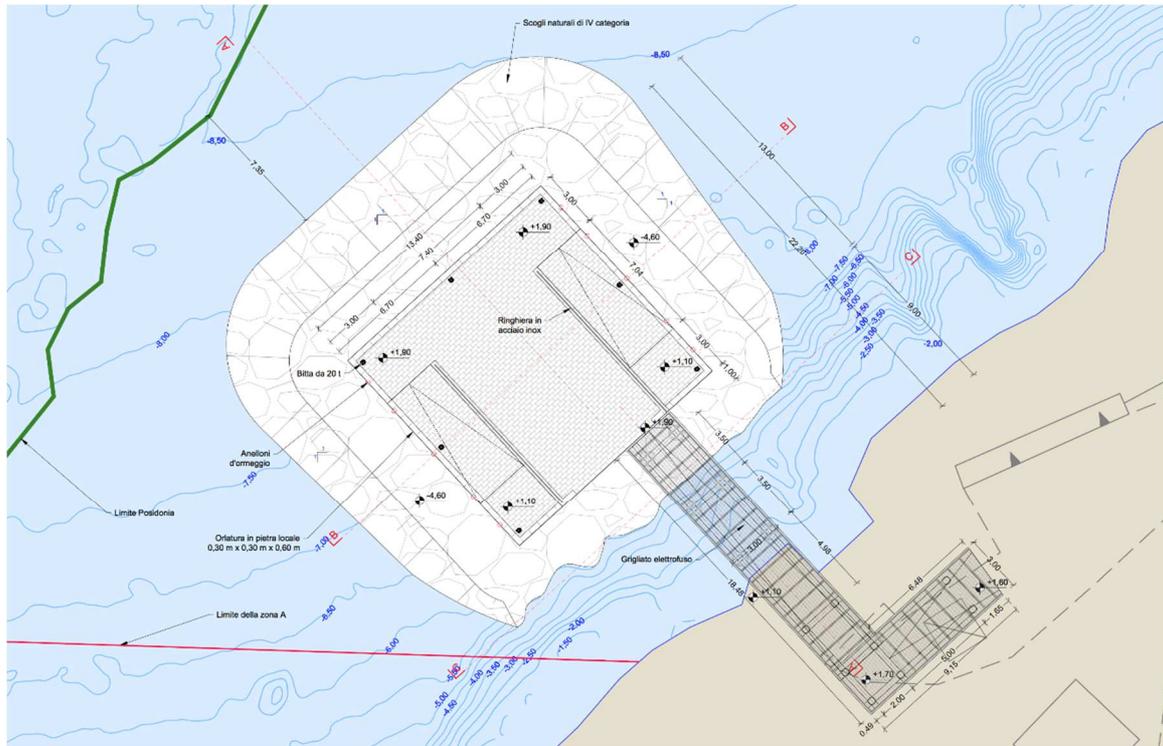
Alternativa 5: Planimetria al finito estratto da 2017E037INV-02-D-OM-TAV001
